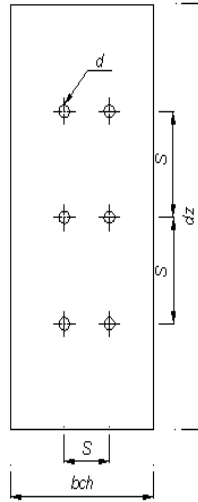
Dimensionamiento zona de panel - soldaduras de tapón
